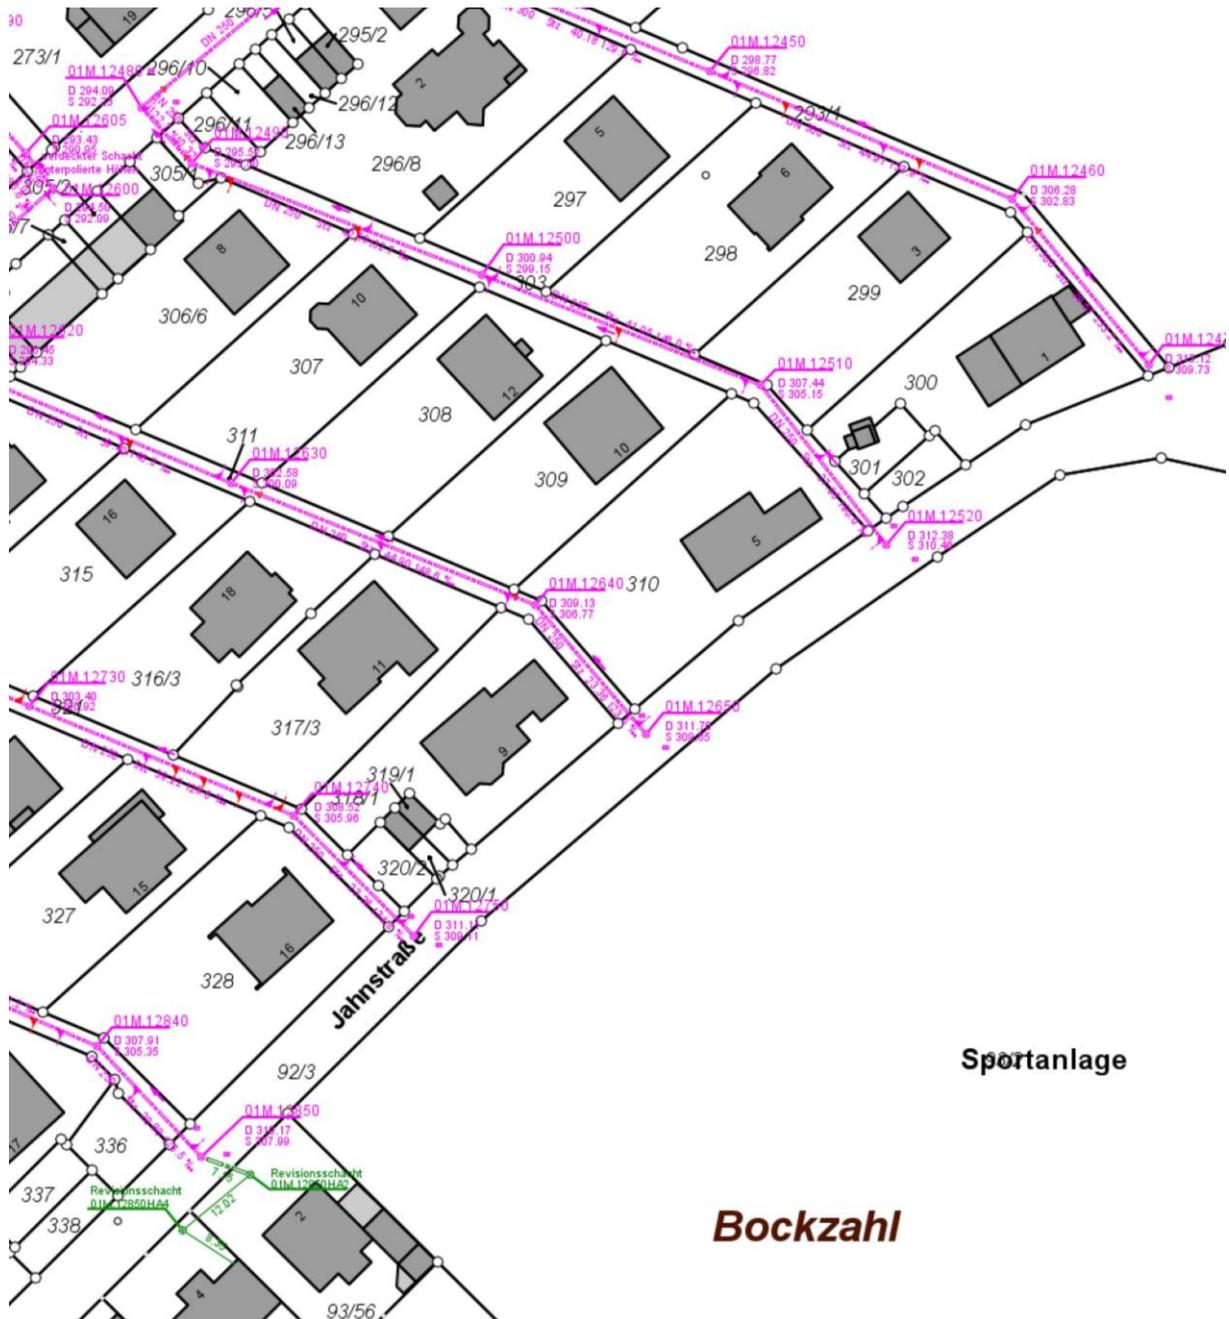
Vorhandene Kanalisation westlich der Jahnstraße
